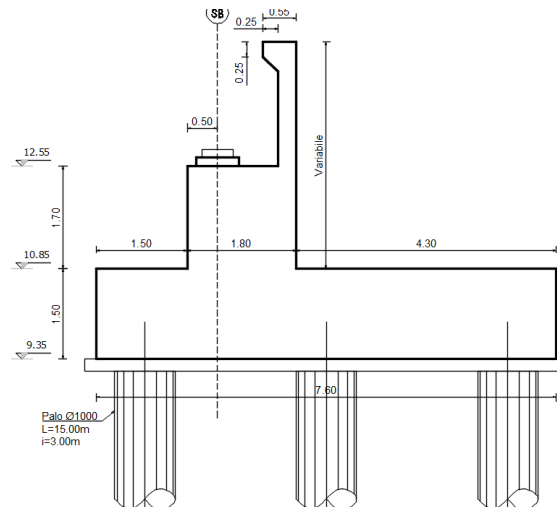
Profilo spalla "SB" lato Ramo Bidirezionale 1
